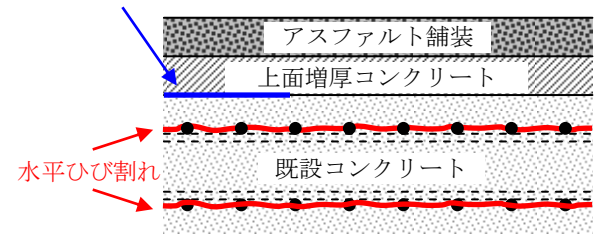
道路橋 RC 床版の水平ひび割れ発生位置
